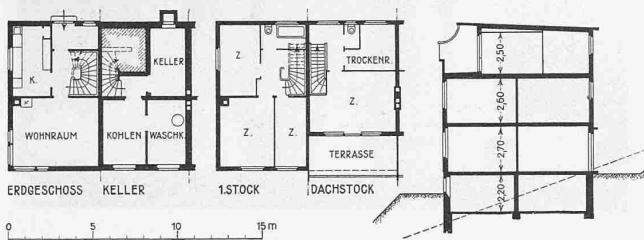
Grundrisse und Schnitt. — Masstab 1 : 400.
